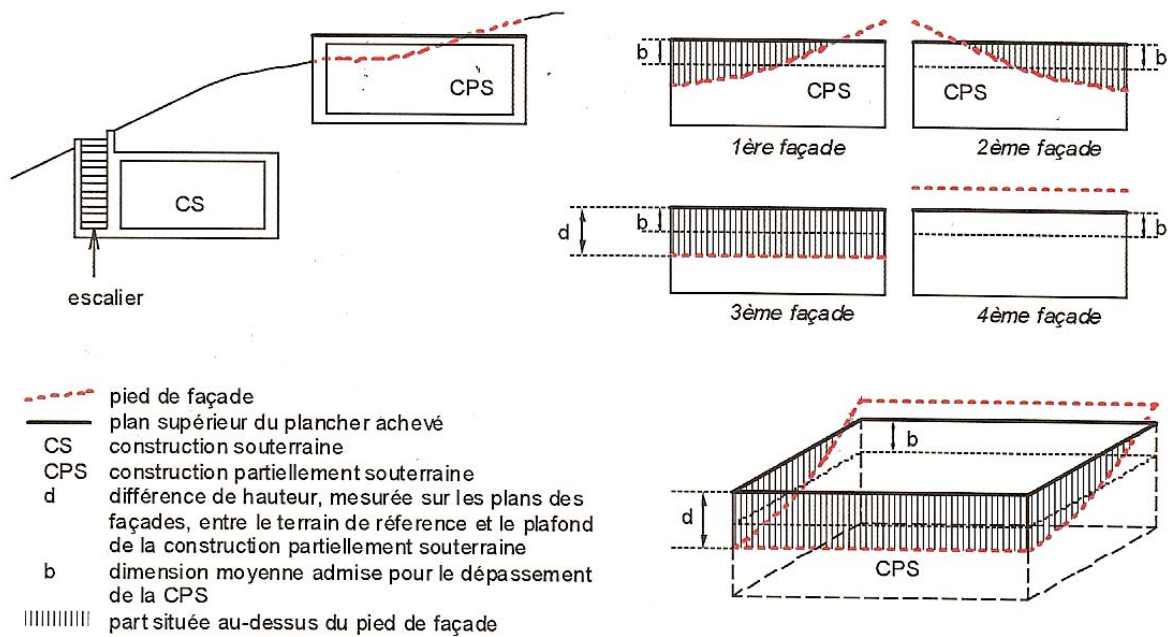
et 2.5 Constructions souterraines, constructions partiellement souterraines
